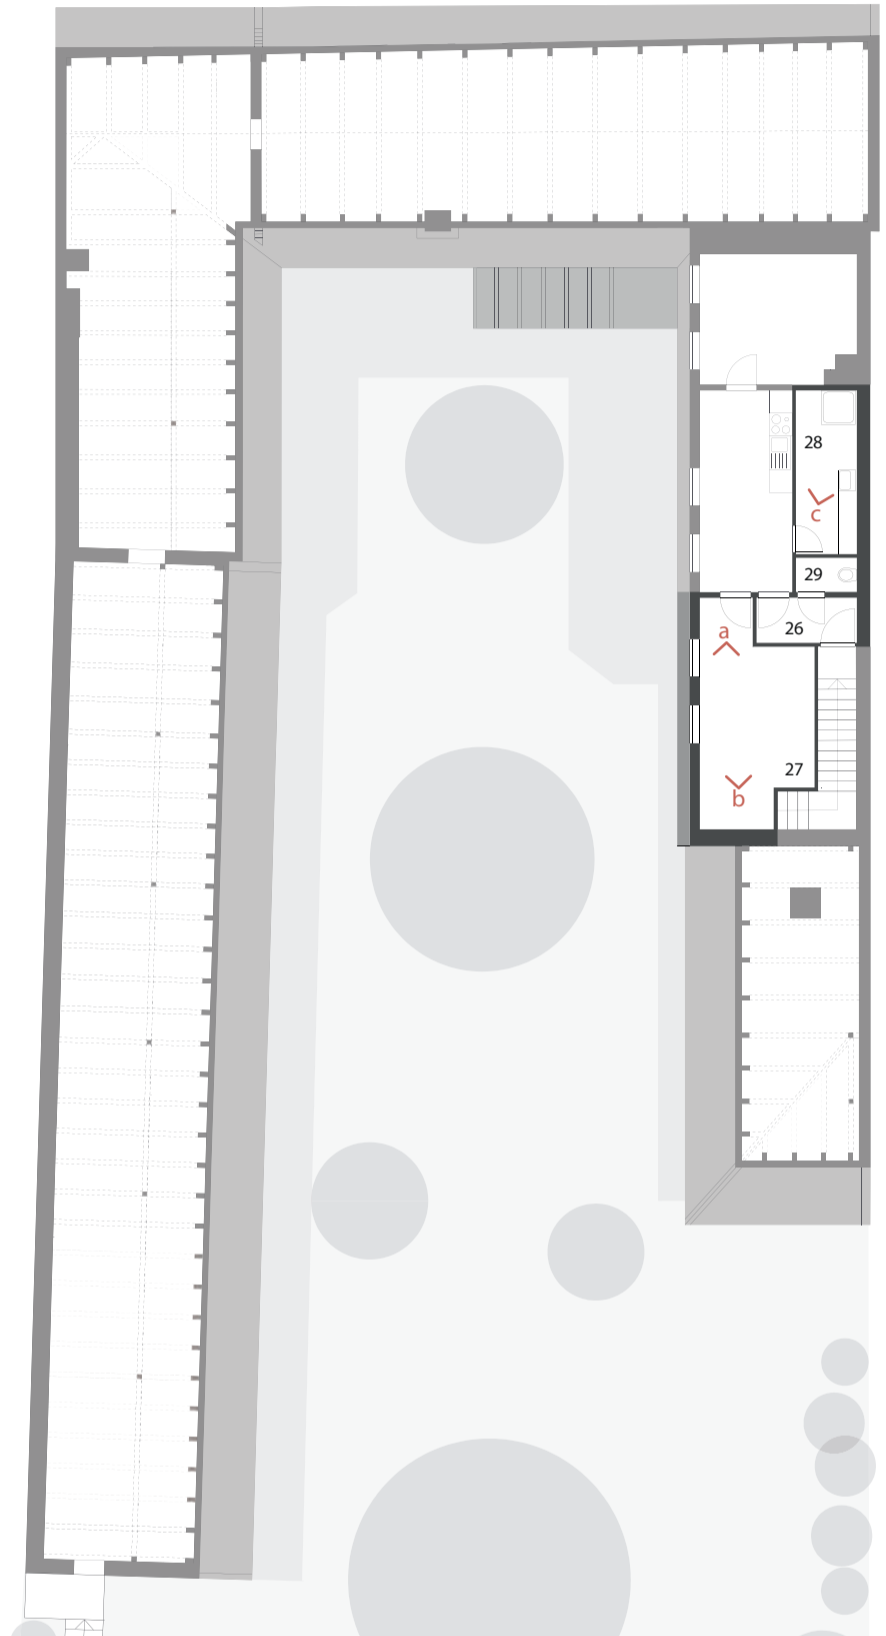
Grundriss Dachgeschoß | M 1:200 | Raum 26, 27, 28, 29
